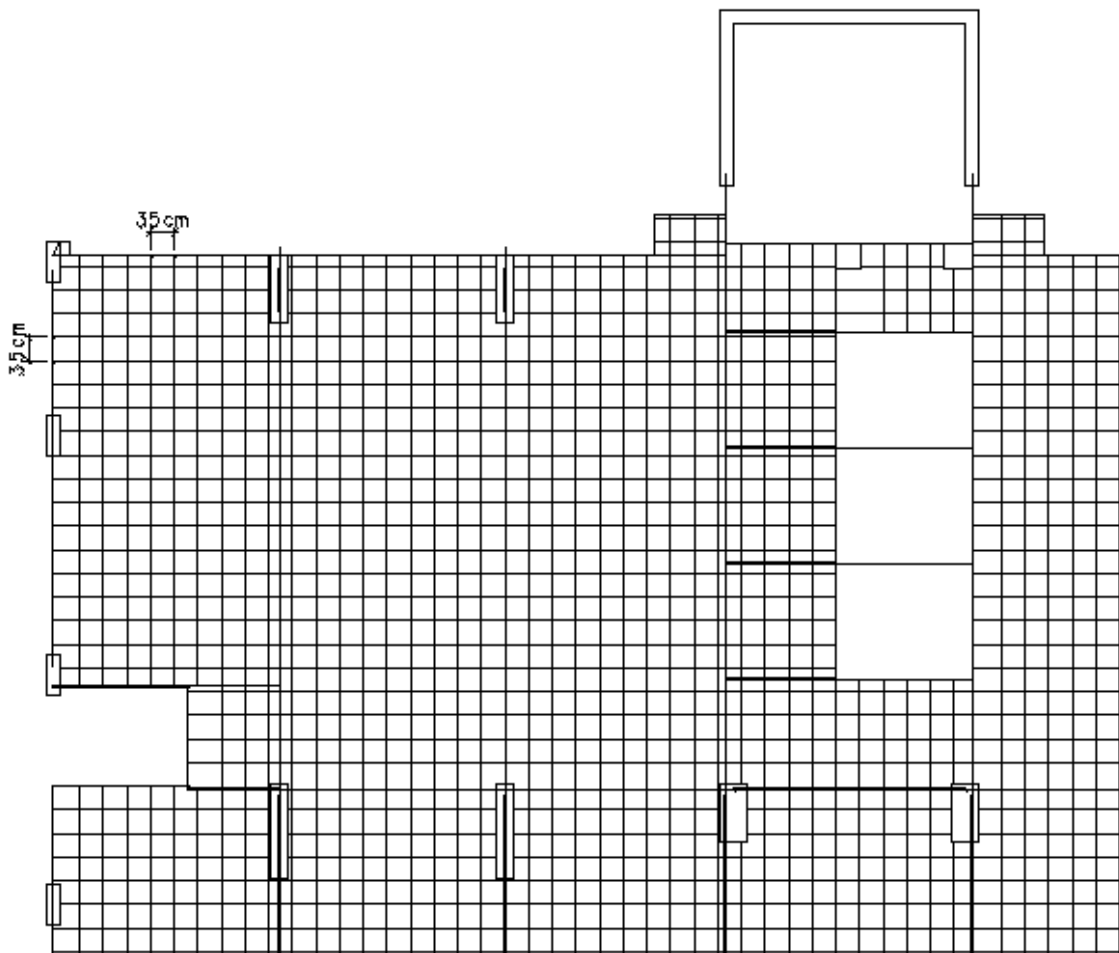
Malha de 35 x 35 cm da grelha das lajes e vigas de parte do pavimento tipo.
